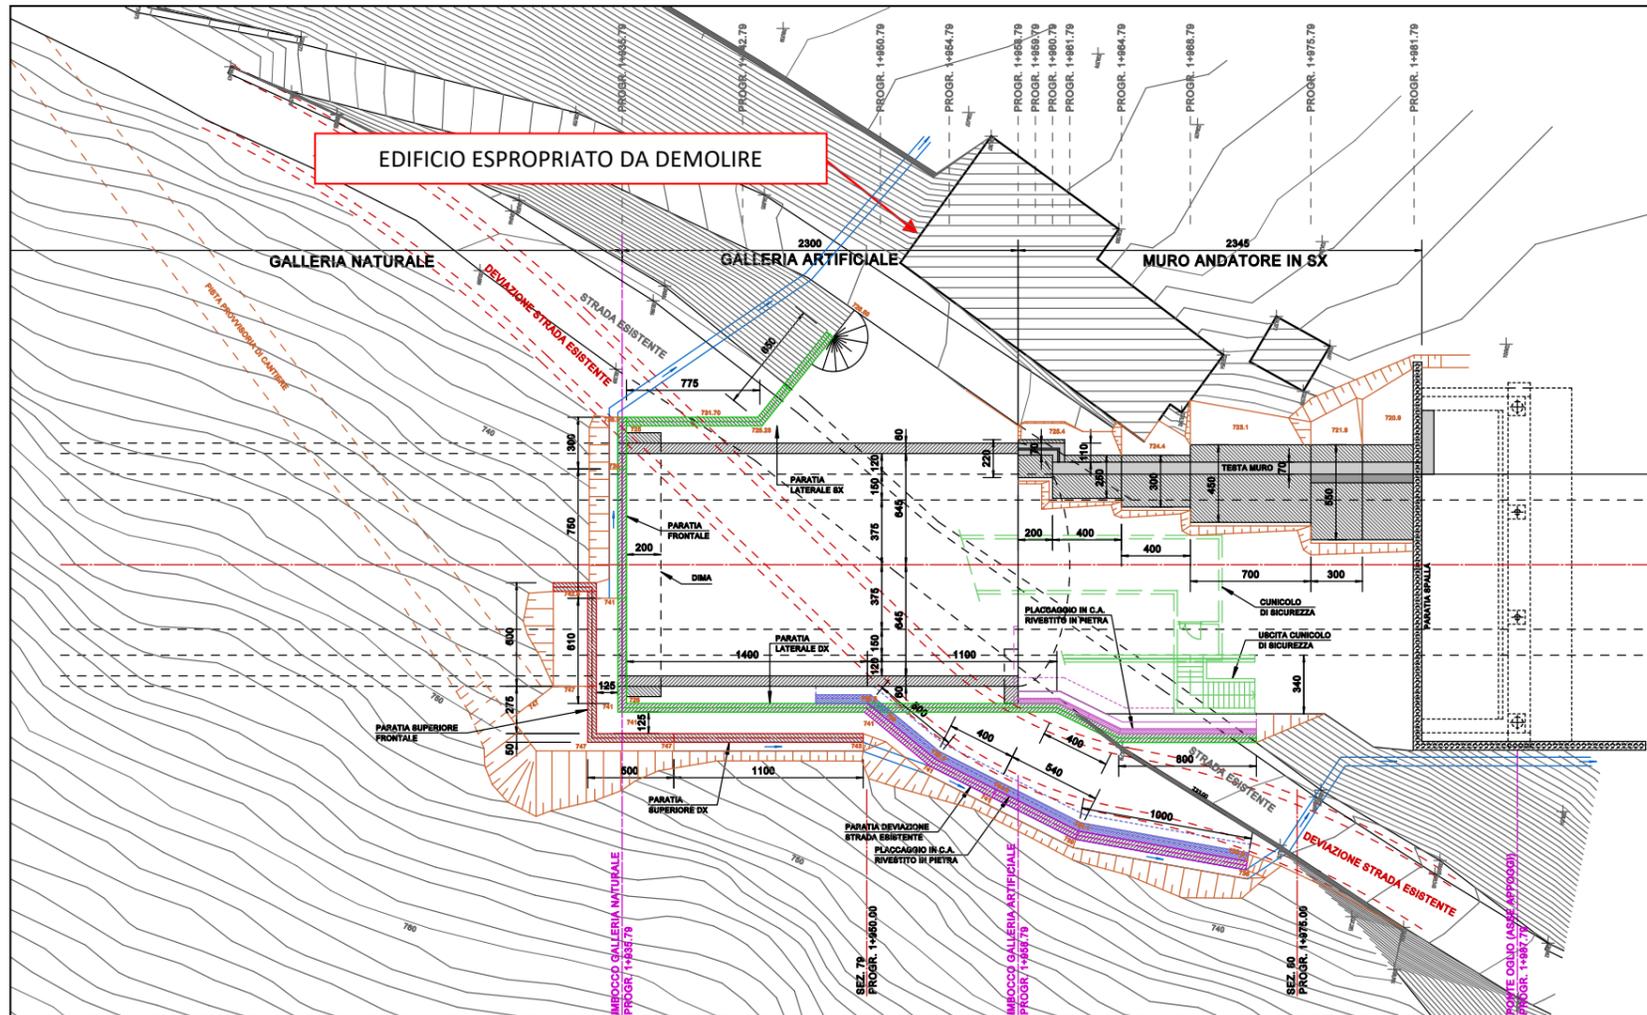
Galleria naturale Imbocco – Paratie berlinesi – Pianta
